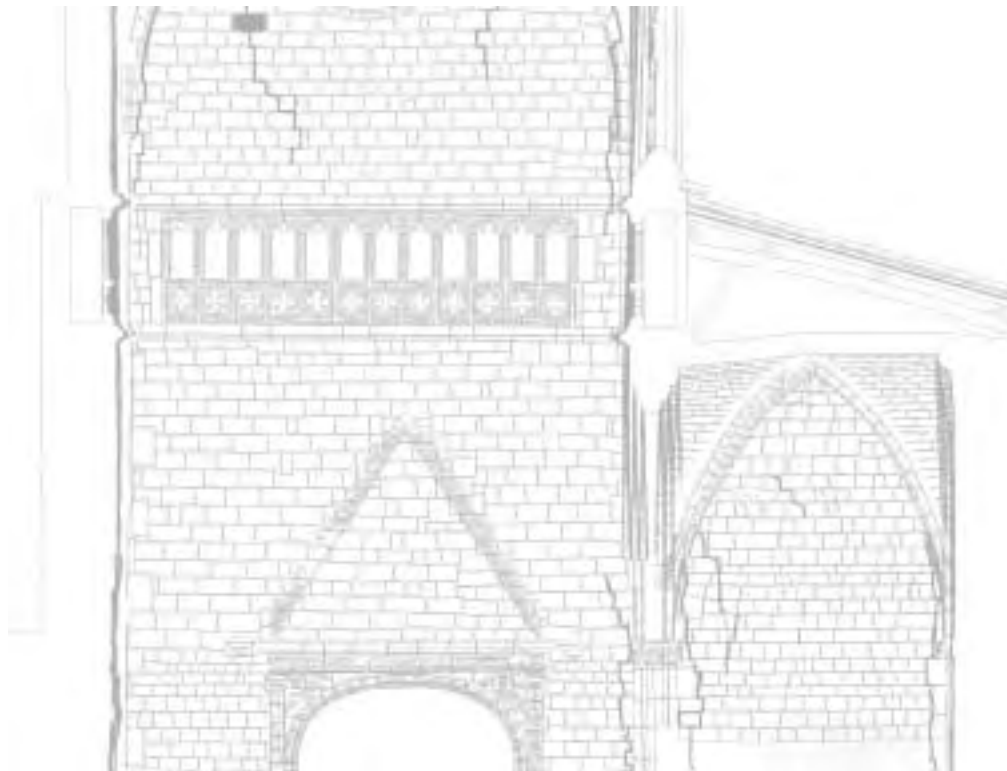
Sección del transepto hacia el norte. Fisuras
